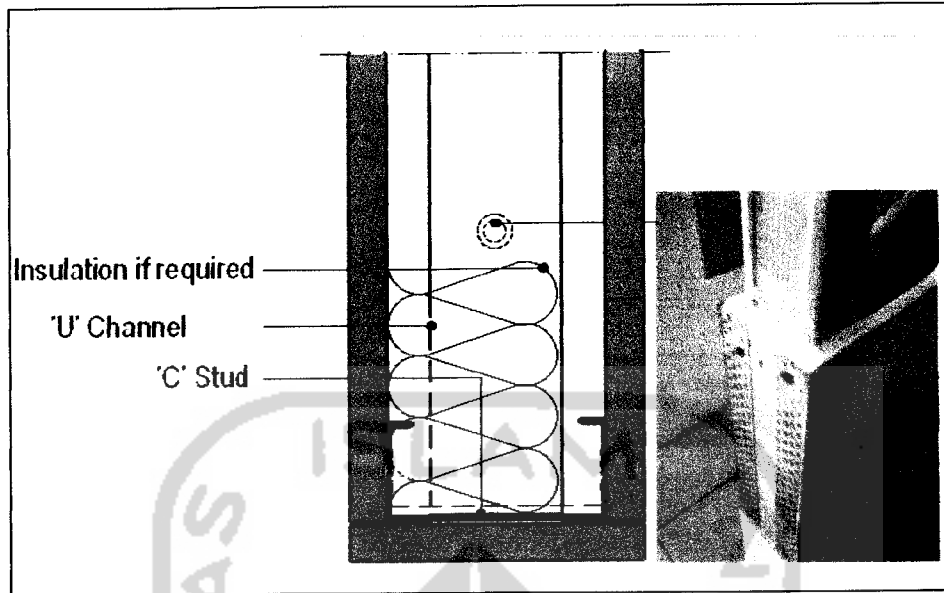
Detail Partition to Ceiling dan Head Track
